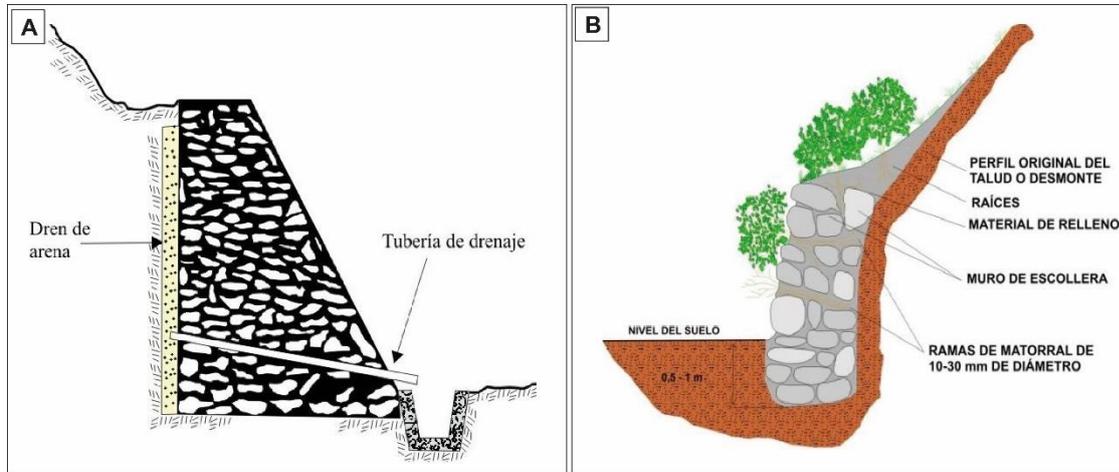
a). Muro de gravedad de piedra seca. b) Muros de gravedad de piedra argamasada
